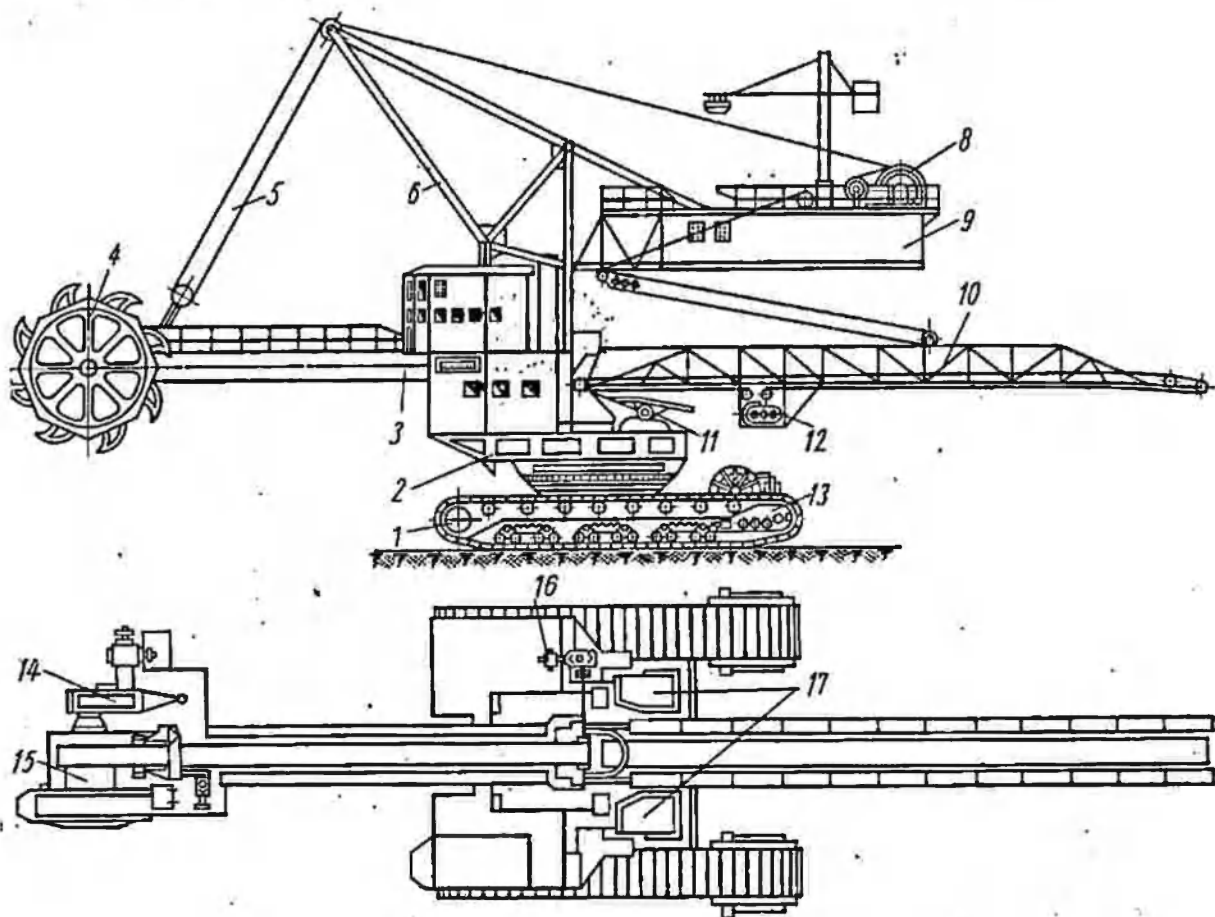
Конструктивная схема роторного экскаватора ЭРГ-400 $\frac{17}{1,5}$;
